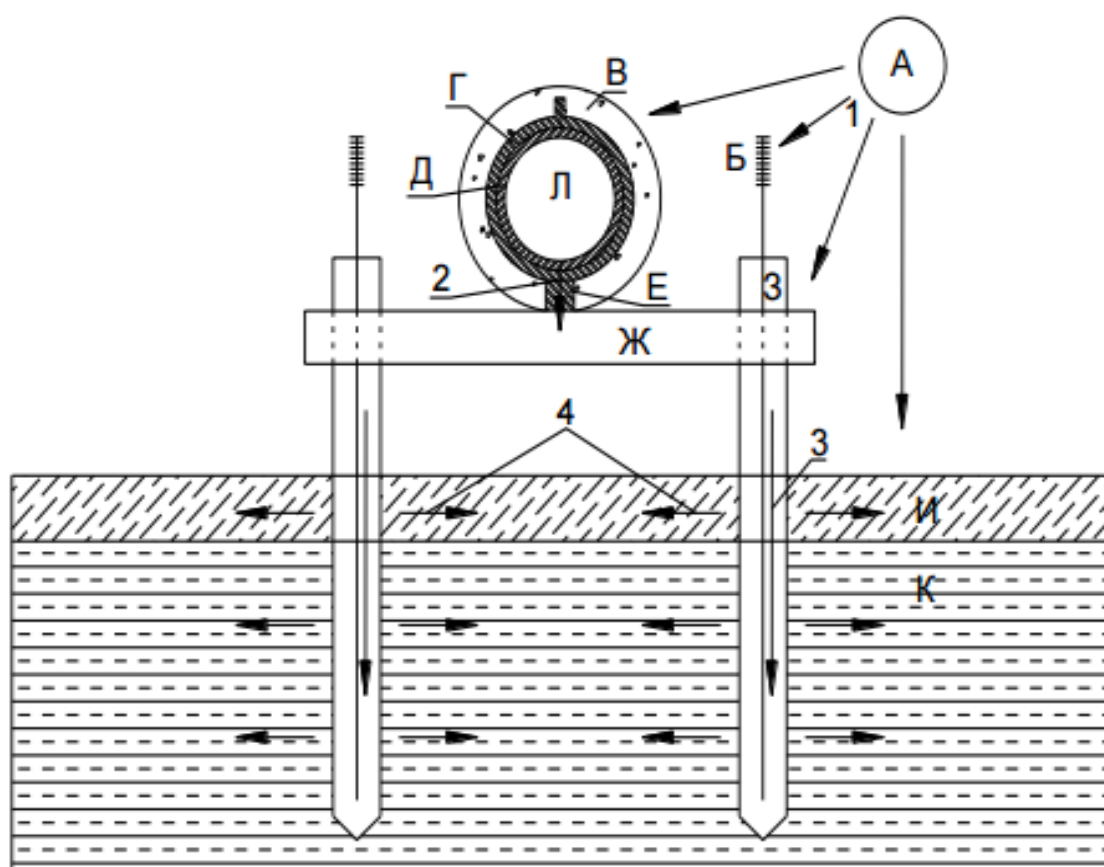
Разрез надземного трубопровода на свайном фундаменте, погруженном в многолетнемерзлый грунт
